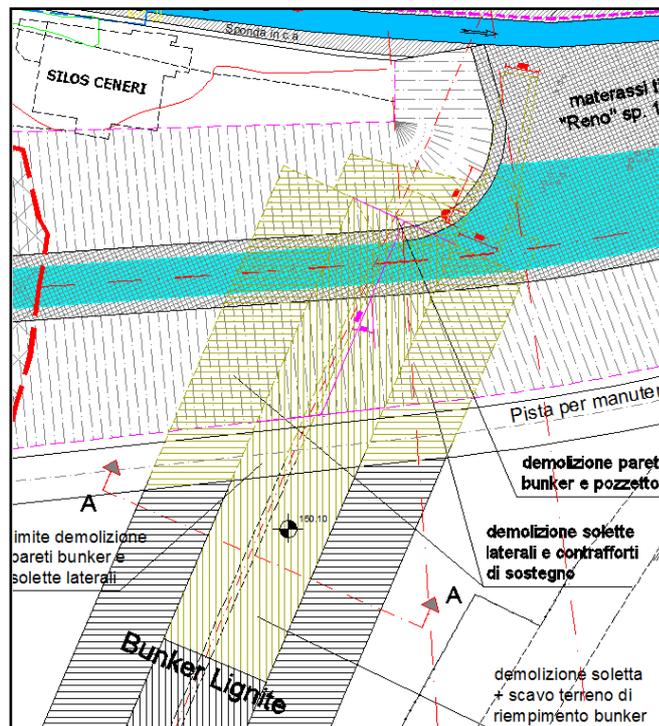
PLANIMETRIA ZONA BUNKER (PART. TAV. 11)
